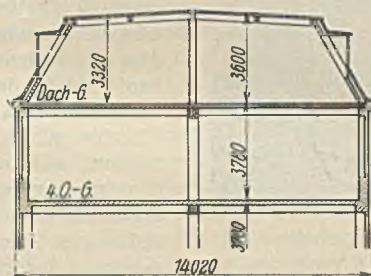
Querschnitt des betroffenen Gebäudeteiles.
